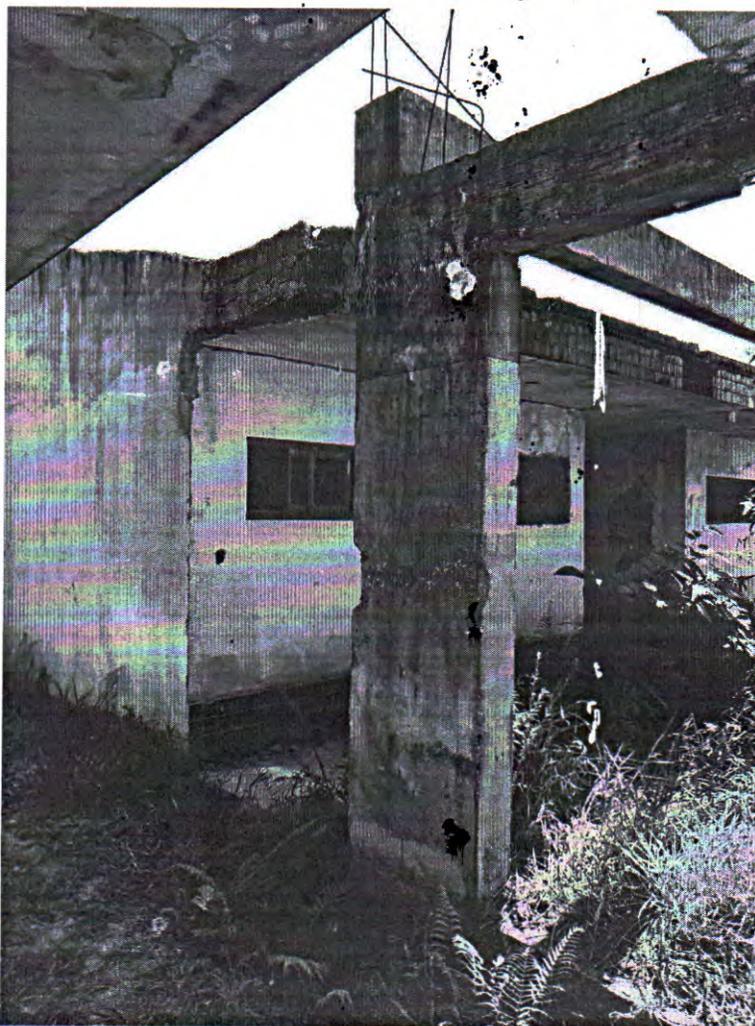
Pilar da área externa com armaduras expostas. Fonte: Acervo Técnico.
